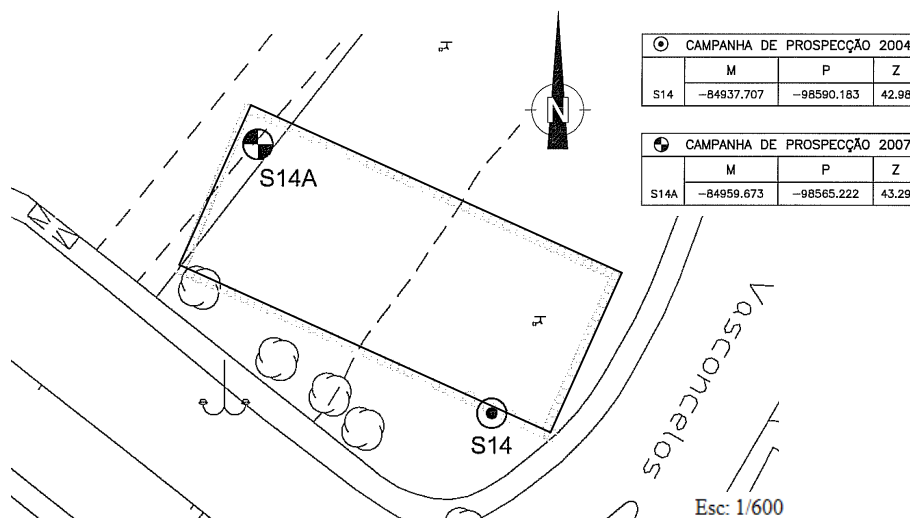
Planta de localização da prospeção geotécnica complementar do PV-192.
